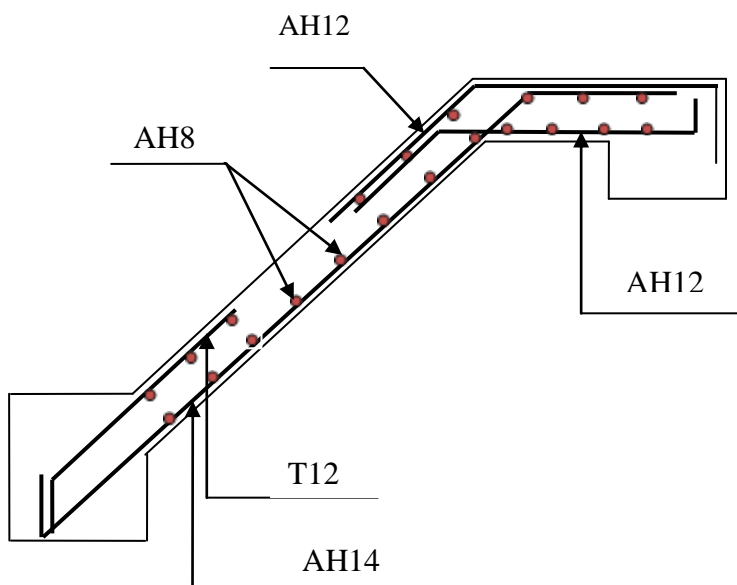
Schémas du ferrailage de la volée I de l'escalier type I
